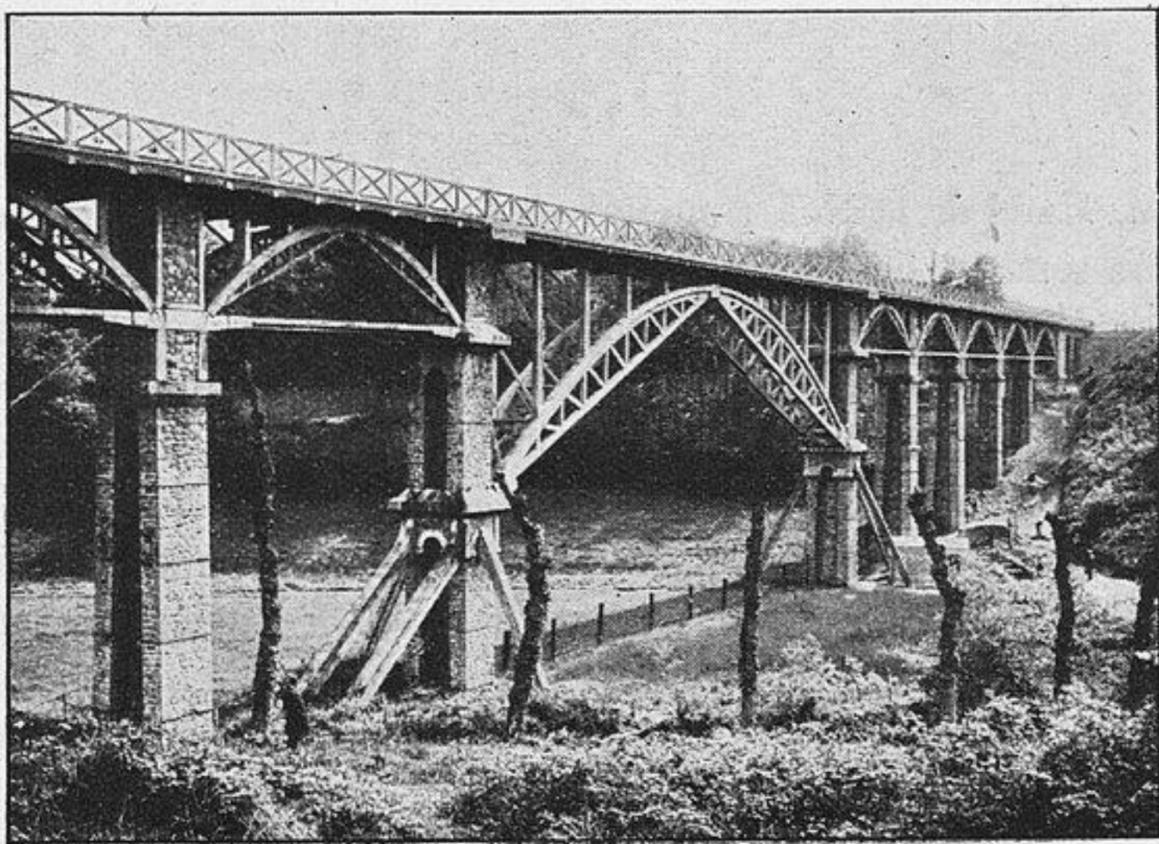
Ligne de Guingamp à Bourbriac. — *Viaduc de Cadolan* (construit en 1914-1915). Longueur totale, 205 mètres ; hauteur, 17 m. 65 ; largeur, 4 m. 40. Travée centrale. Arc à 3 articulations de 39 mètres. Travées latérales de 12 mètres. Arcs en béton armé à 3 articulations.
